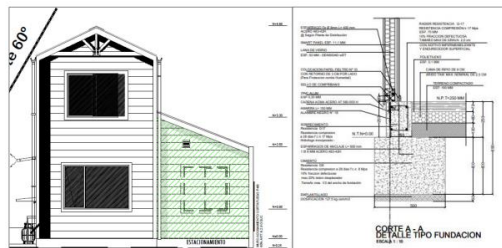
Corte esquemático – Vivienda Tipo 72,42 [m²]
